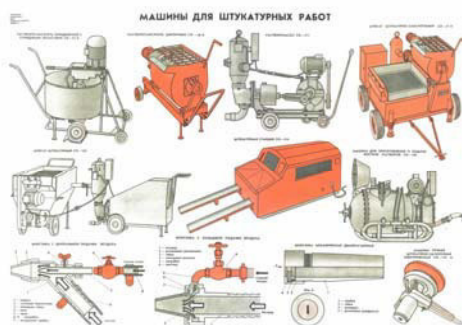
Устройство и оборудование для штукатурных и гидроизоляционных работ
